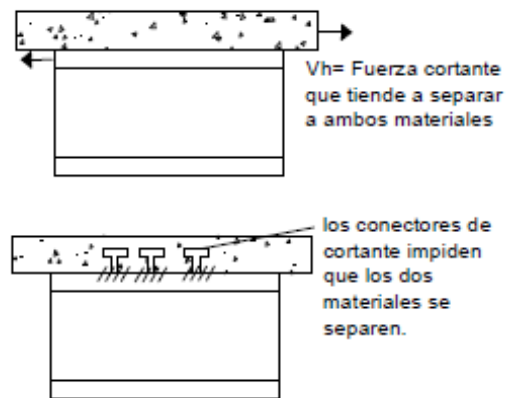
Fuerzas de corte que actúan en la interfaz del hormigón y el acero (Johnston L., 1999)
